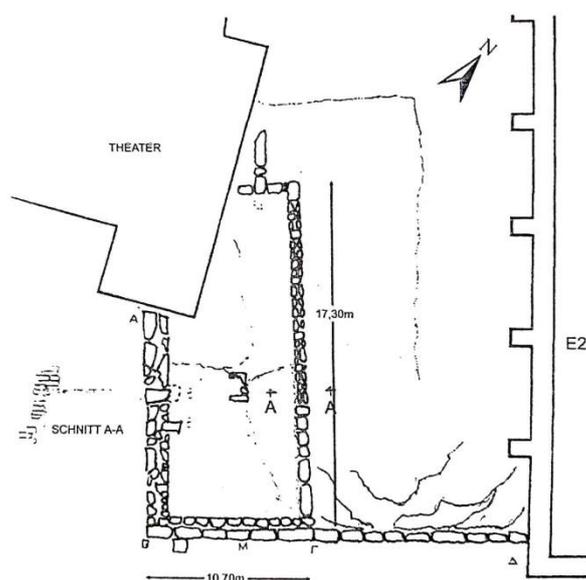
Dodona, planimetria della casa dei sacerdoti (M), DIETERLE 2007, p. 132.
